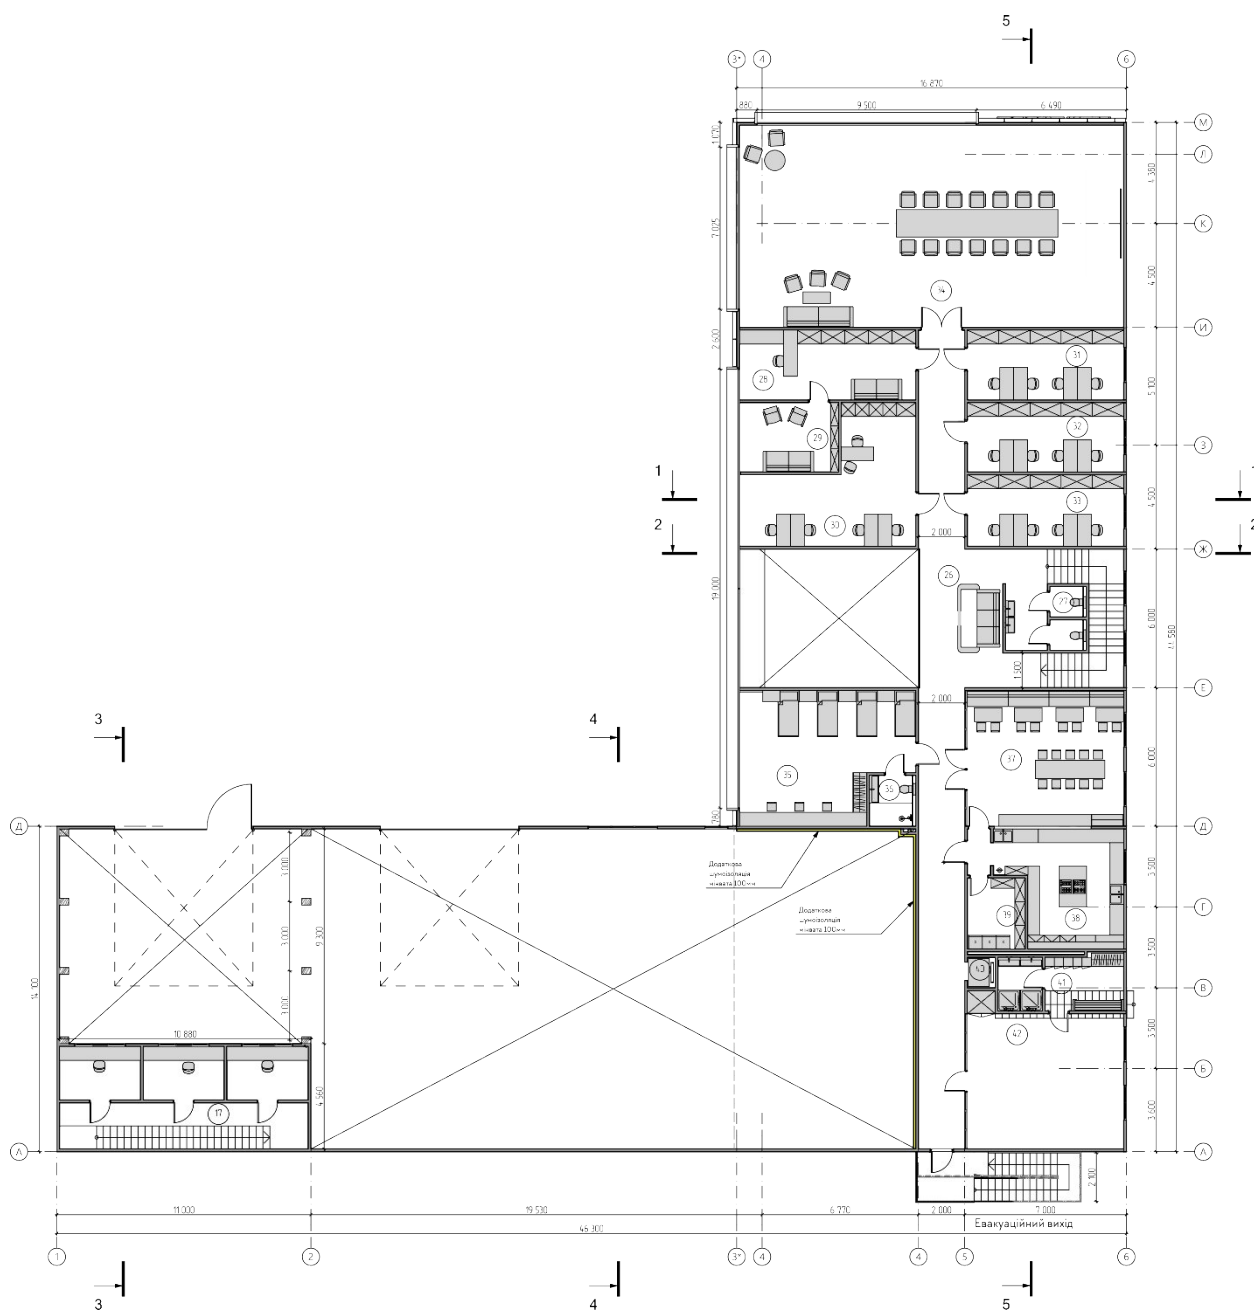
План 2-го поверху на відтмітці +4,000
